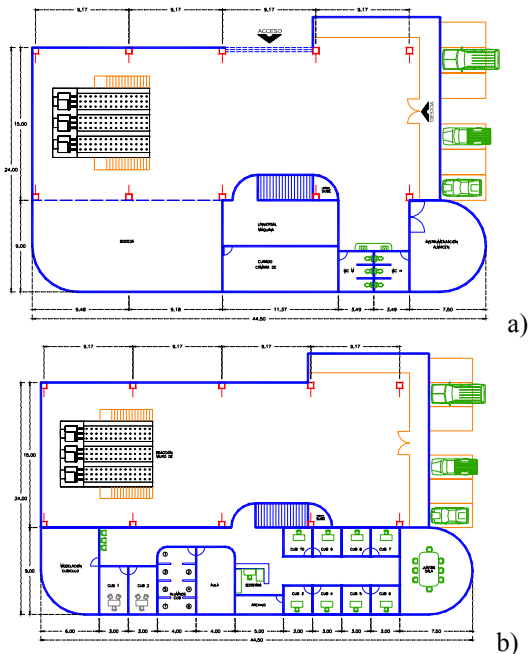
a) Planta baja y b) planta alta del laboratorio de estructuras propuesto
